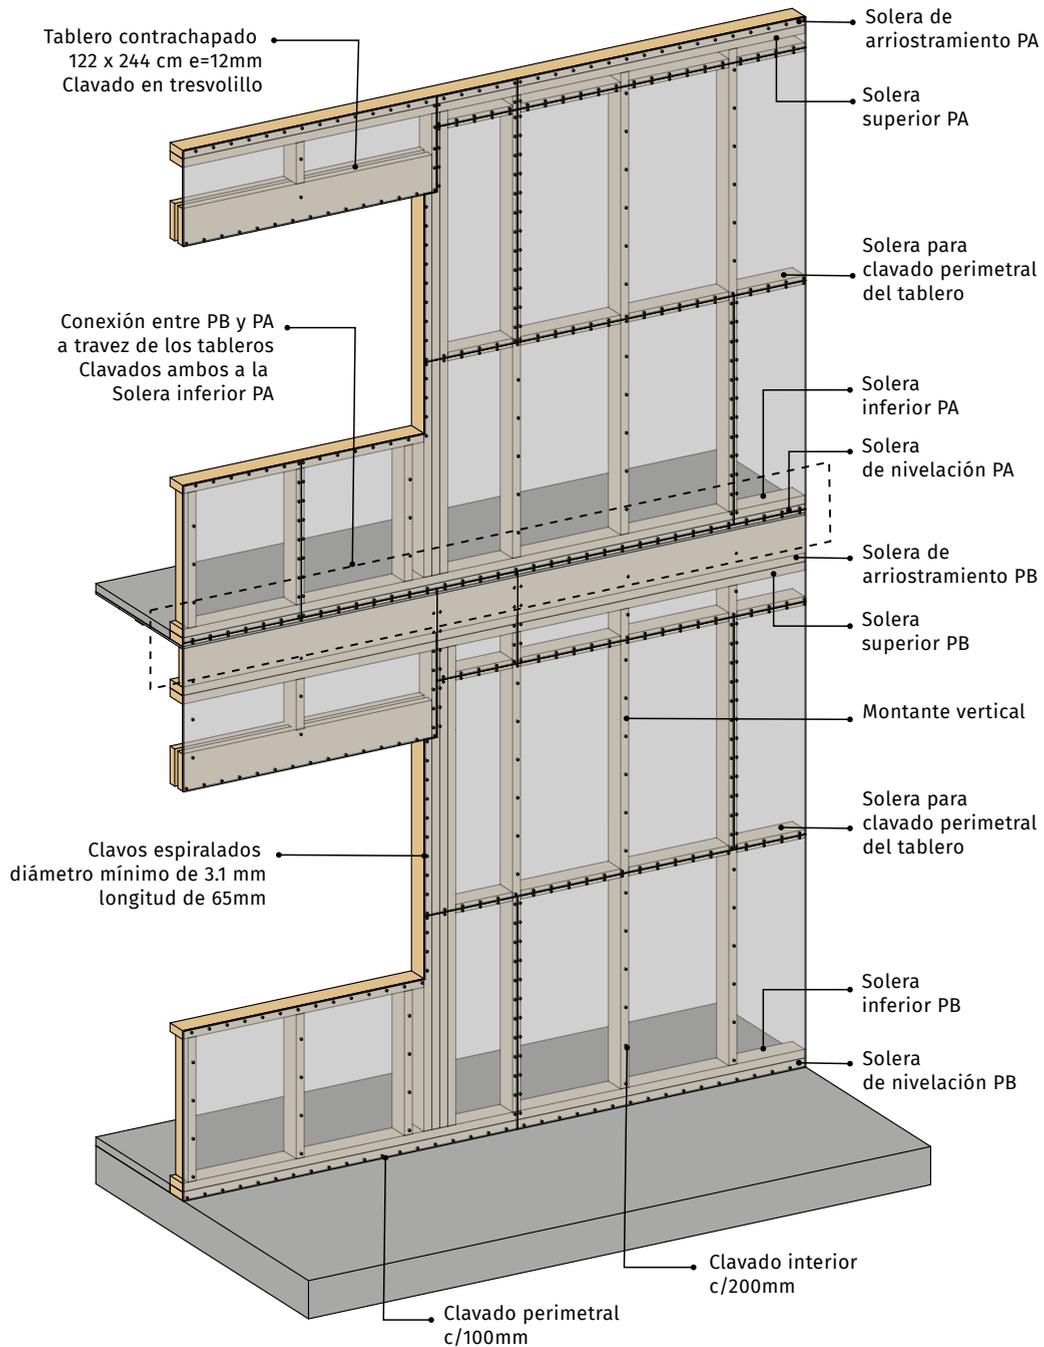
Clavado de los tableros a las soleras y montantes
